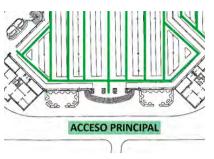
Plano detalle de la entrada principal por la plaza del Mercado
